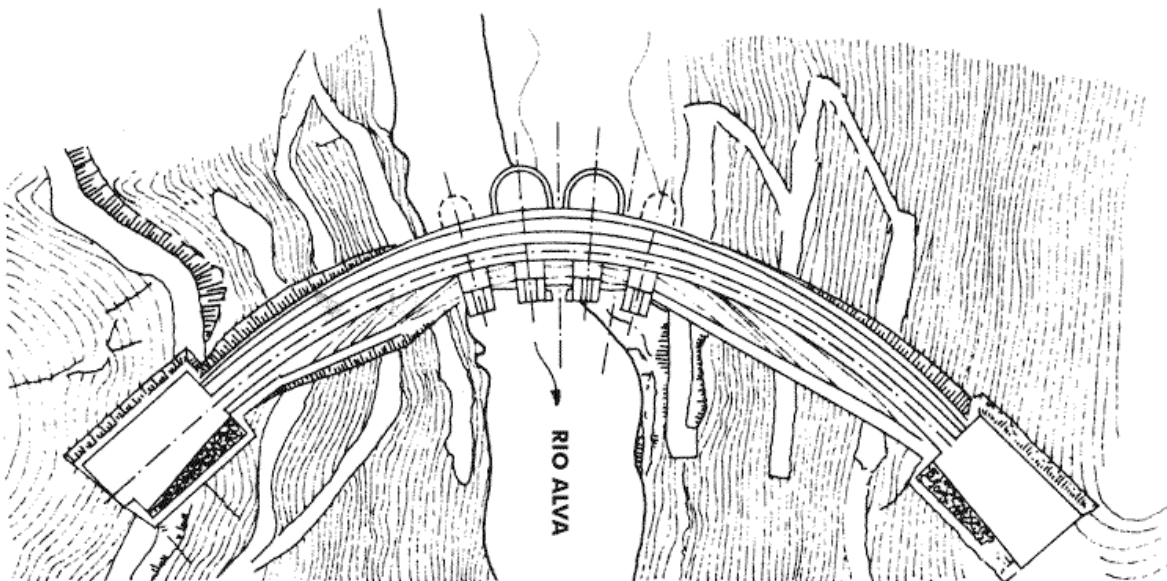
Planta da barragem de Fronhas (Fonte: <http://cnpgeb.inag.pt>)
